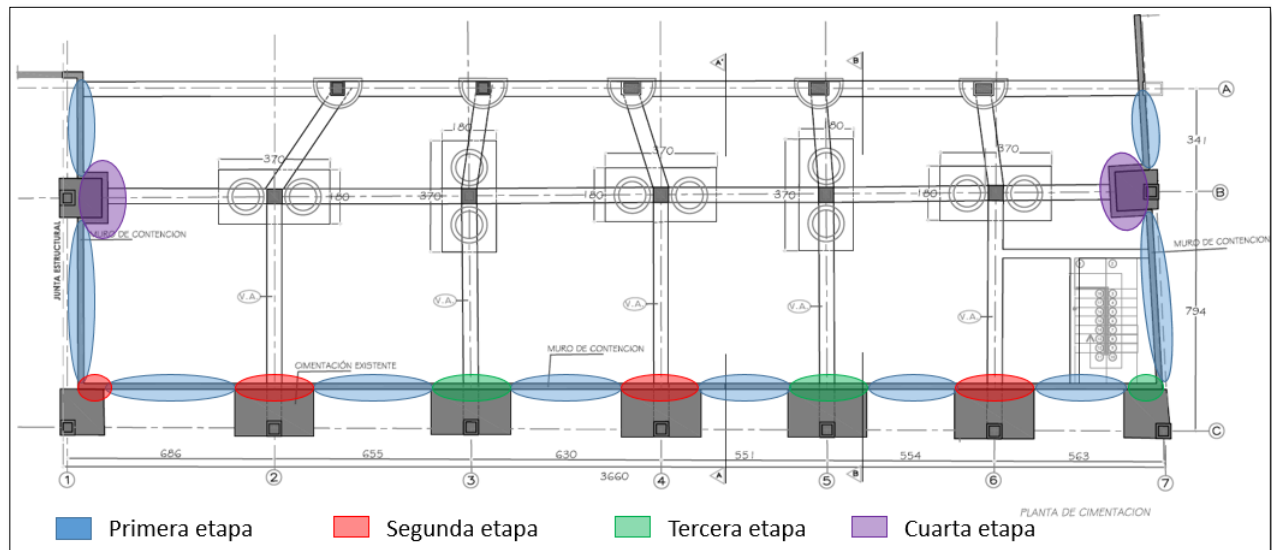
Etapas de construcción muro de contención - Alternativa 2
